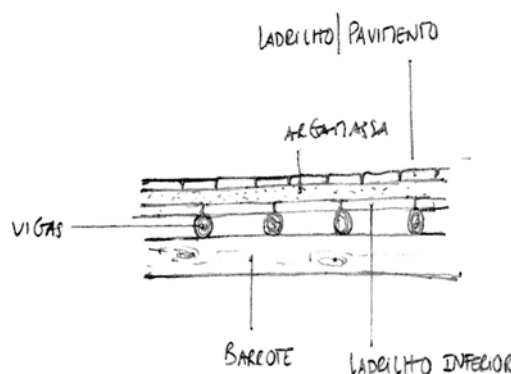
Corte esquemático de sistema construtivo tradicional: mirante algarvio. (Ilustração Nossa, 2017)
